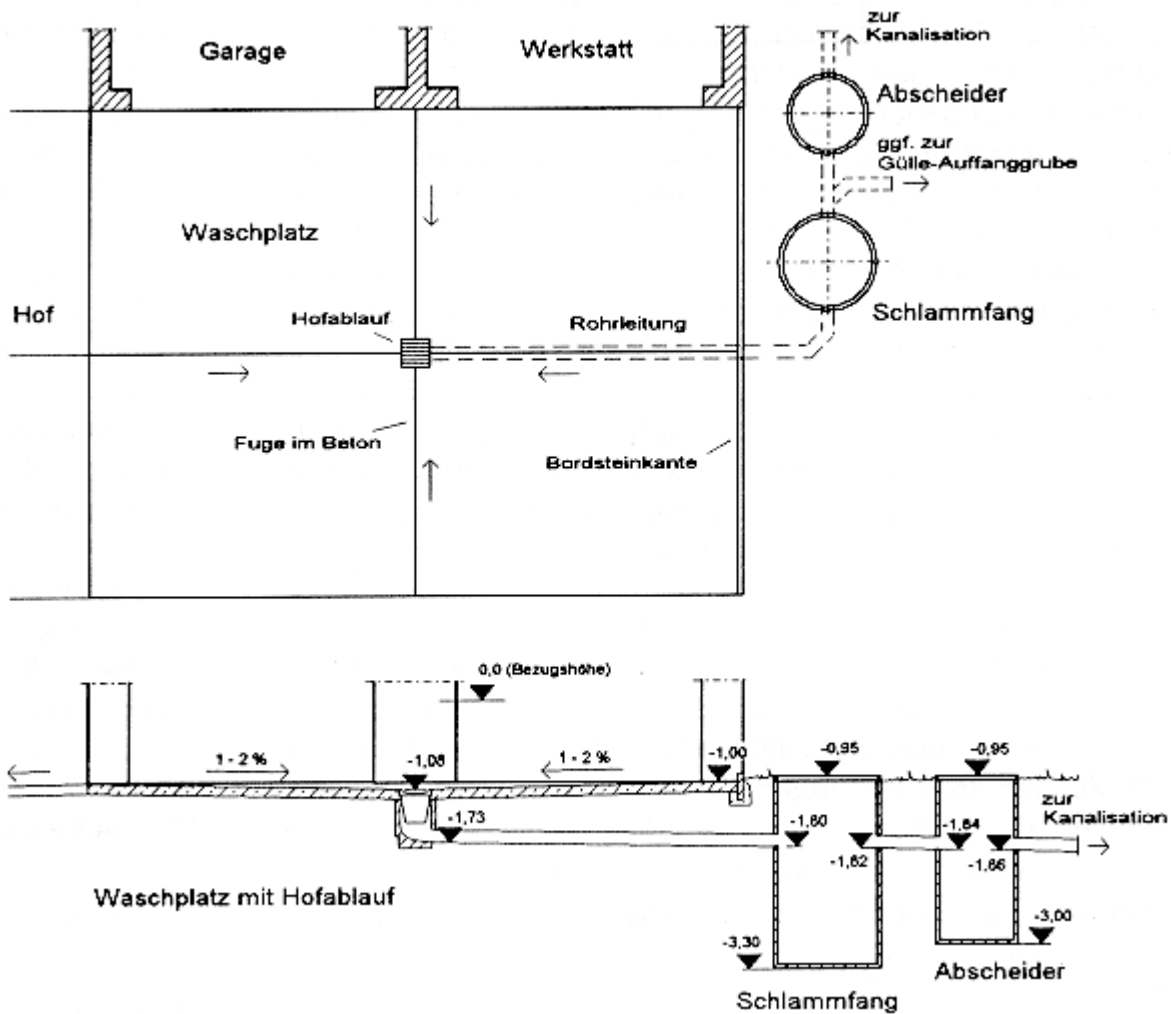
Vor Baubeginn ist sowohl ein Grundriß als auch ein genauer Höhenplan zu erstellen (Beispiel).
